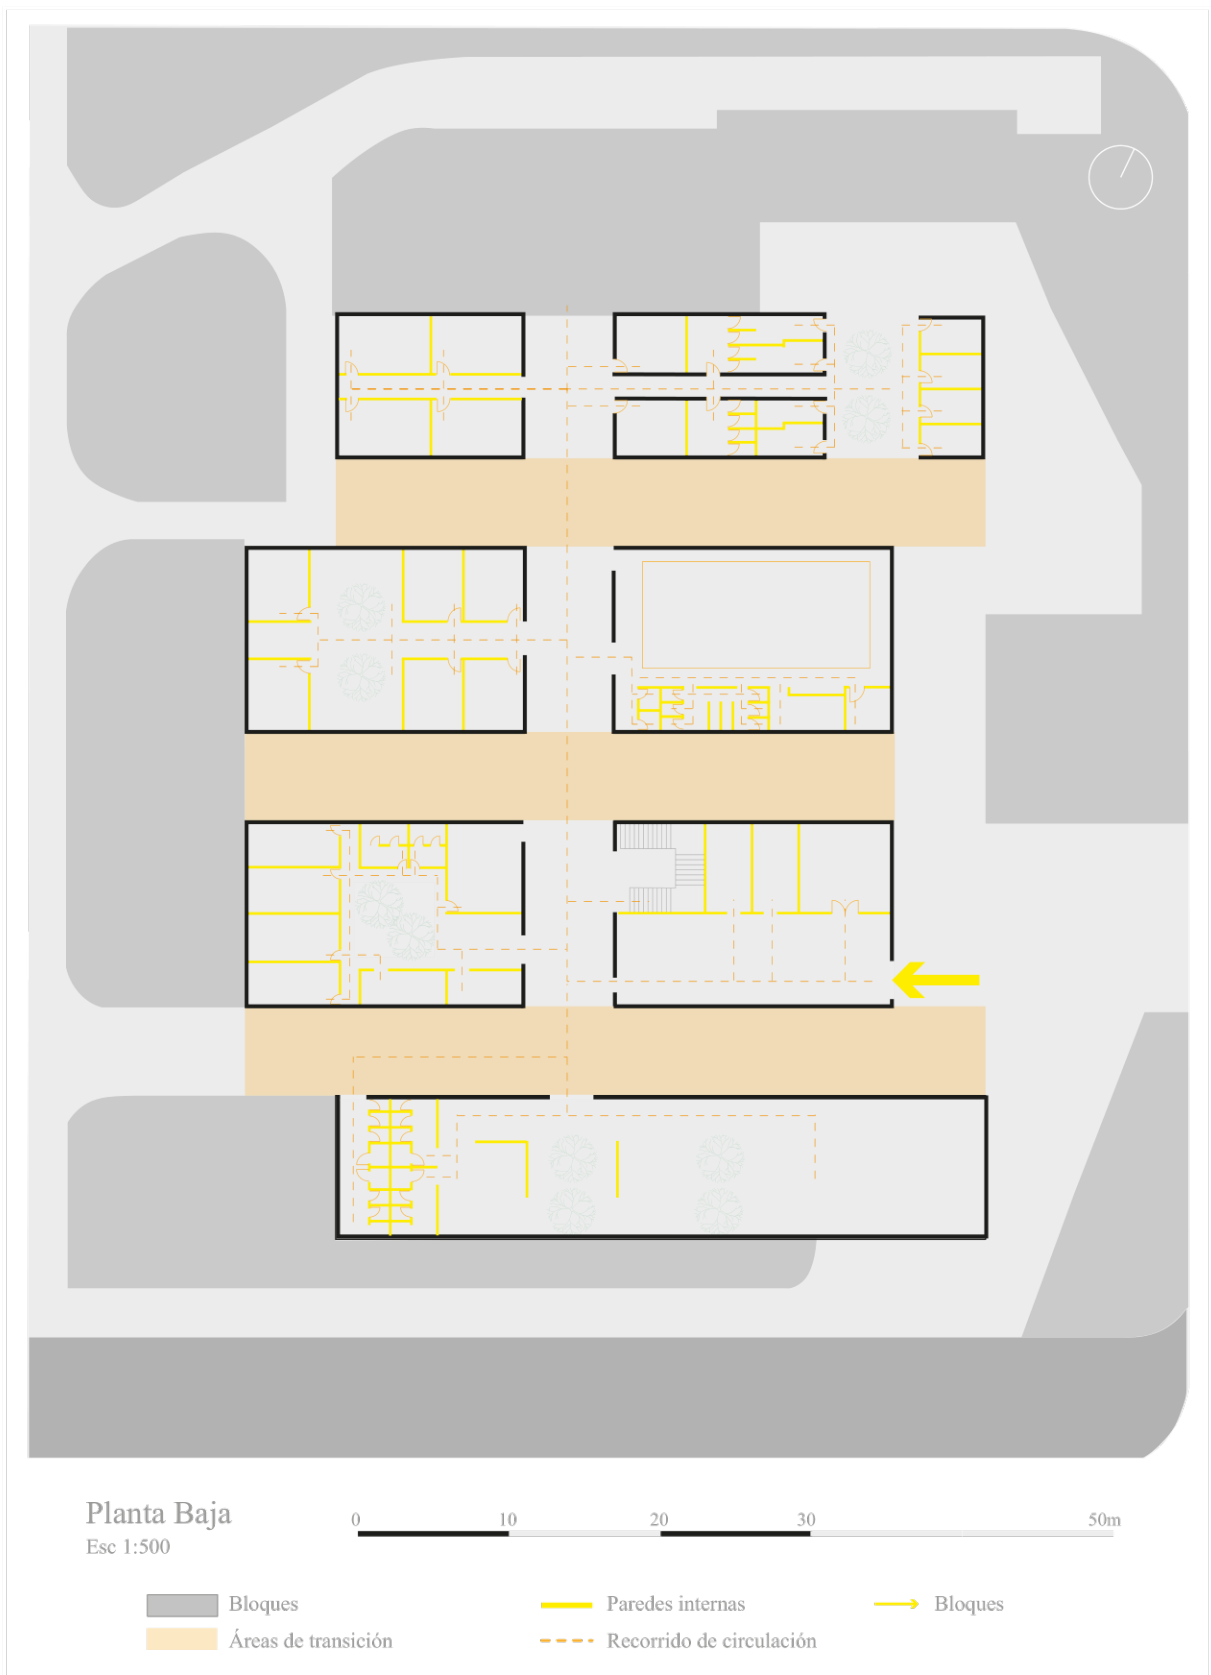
Circulaciones y zonas de transición internas Planta baja
